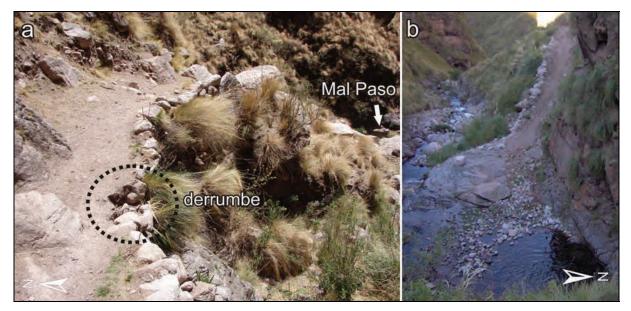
Mal Paso. Camino con talud ladera abajo y excavación ladera arriba:
